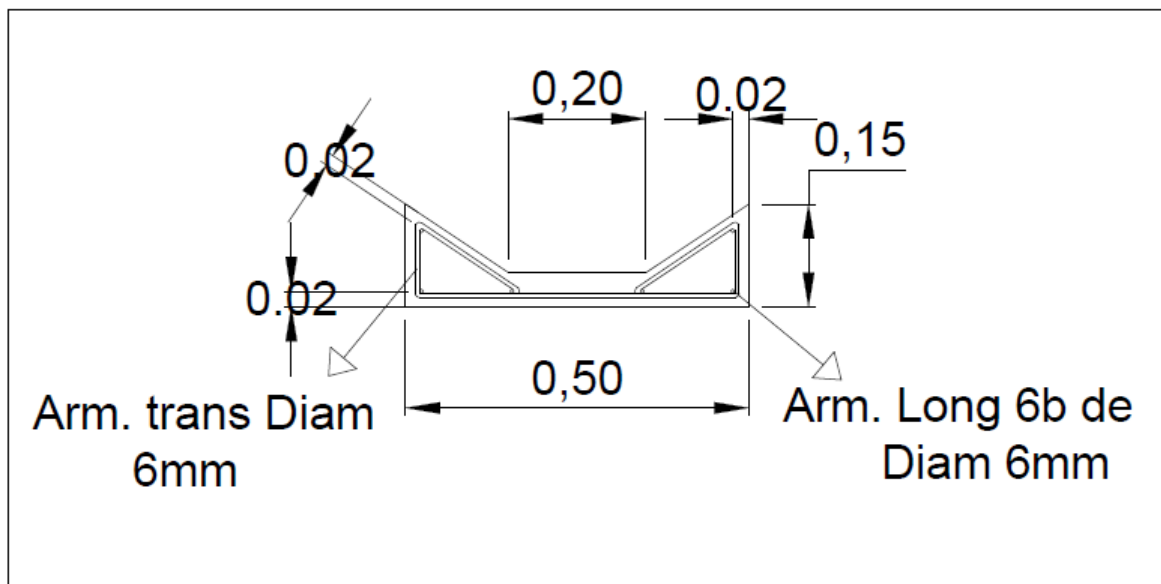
Detalle de armadura de la canaleta pluvial proyectada.
